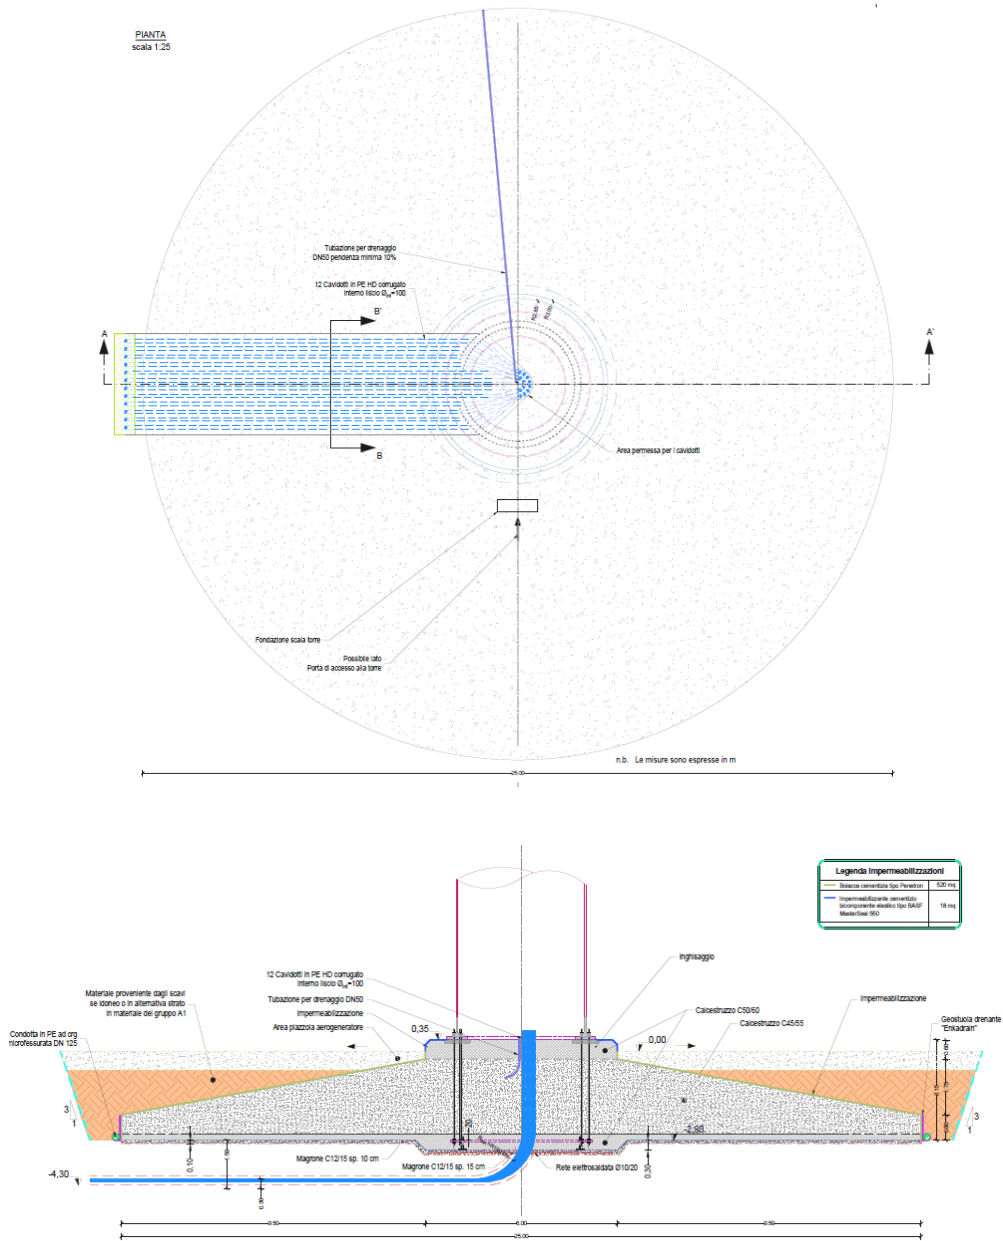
Pianta e sezione del plinto diretto - diametro fondazione 25,00 m
